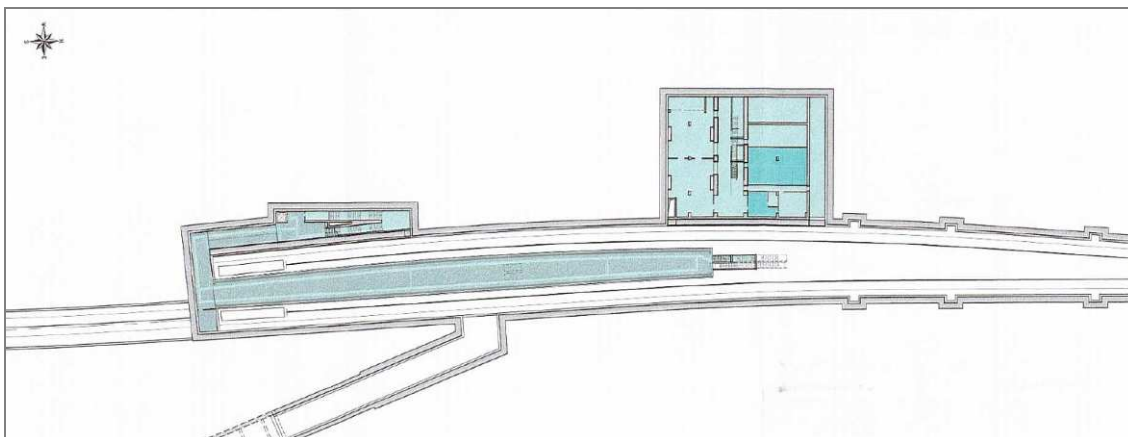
FASE 3 (Realizzazione opere interne: Pavimentazioni)
